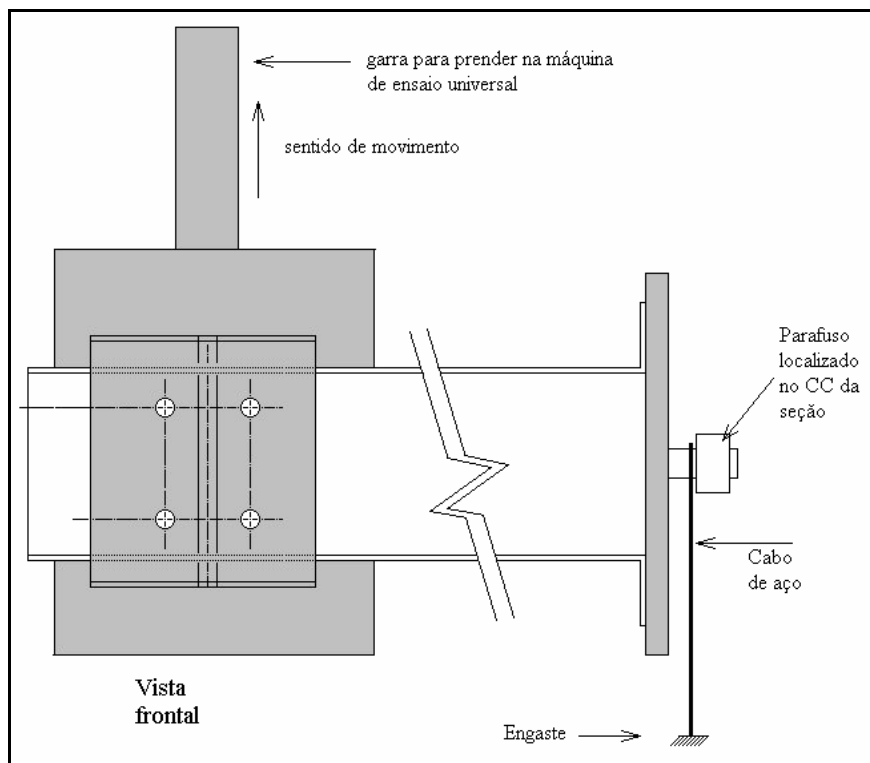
Esquema utilizado no ensaio da viga com 1,5m
